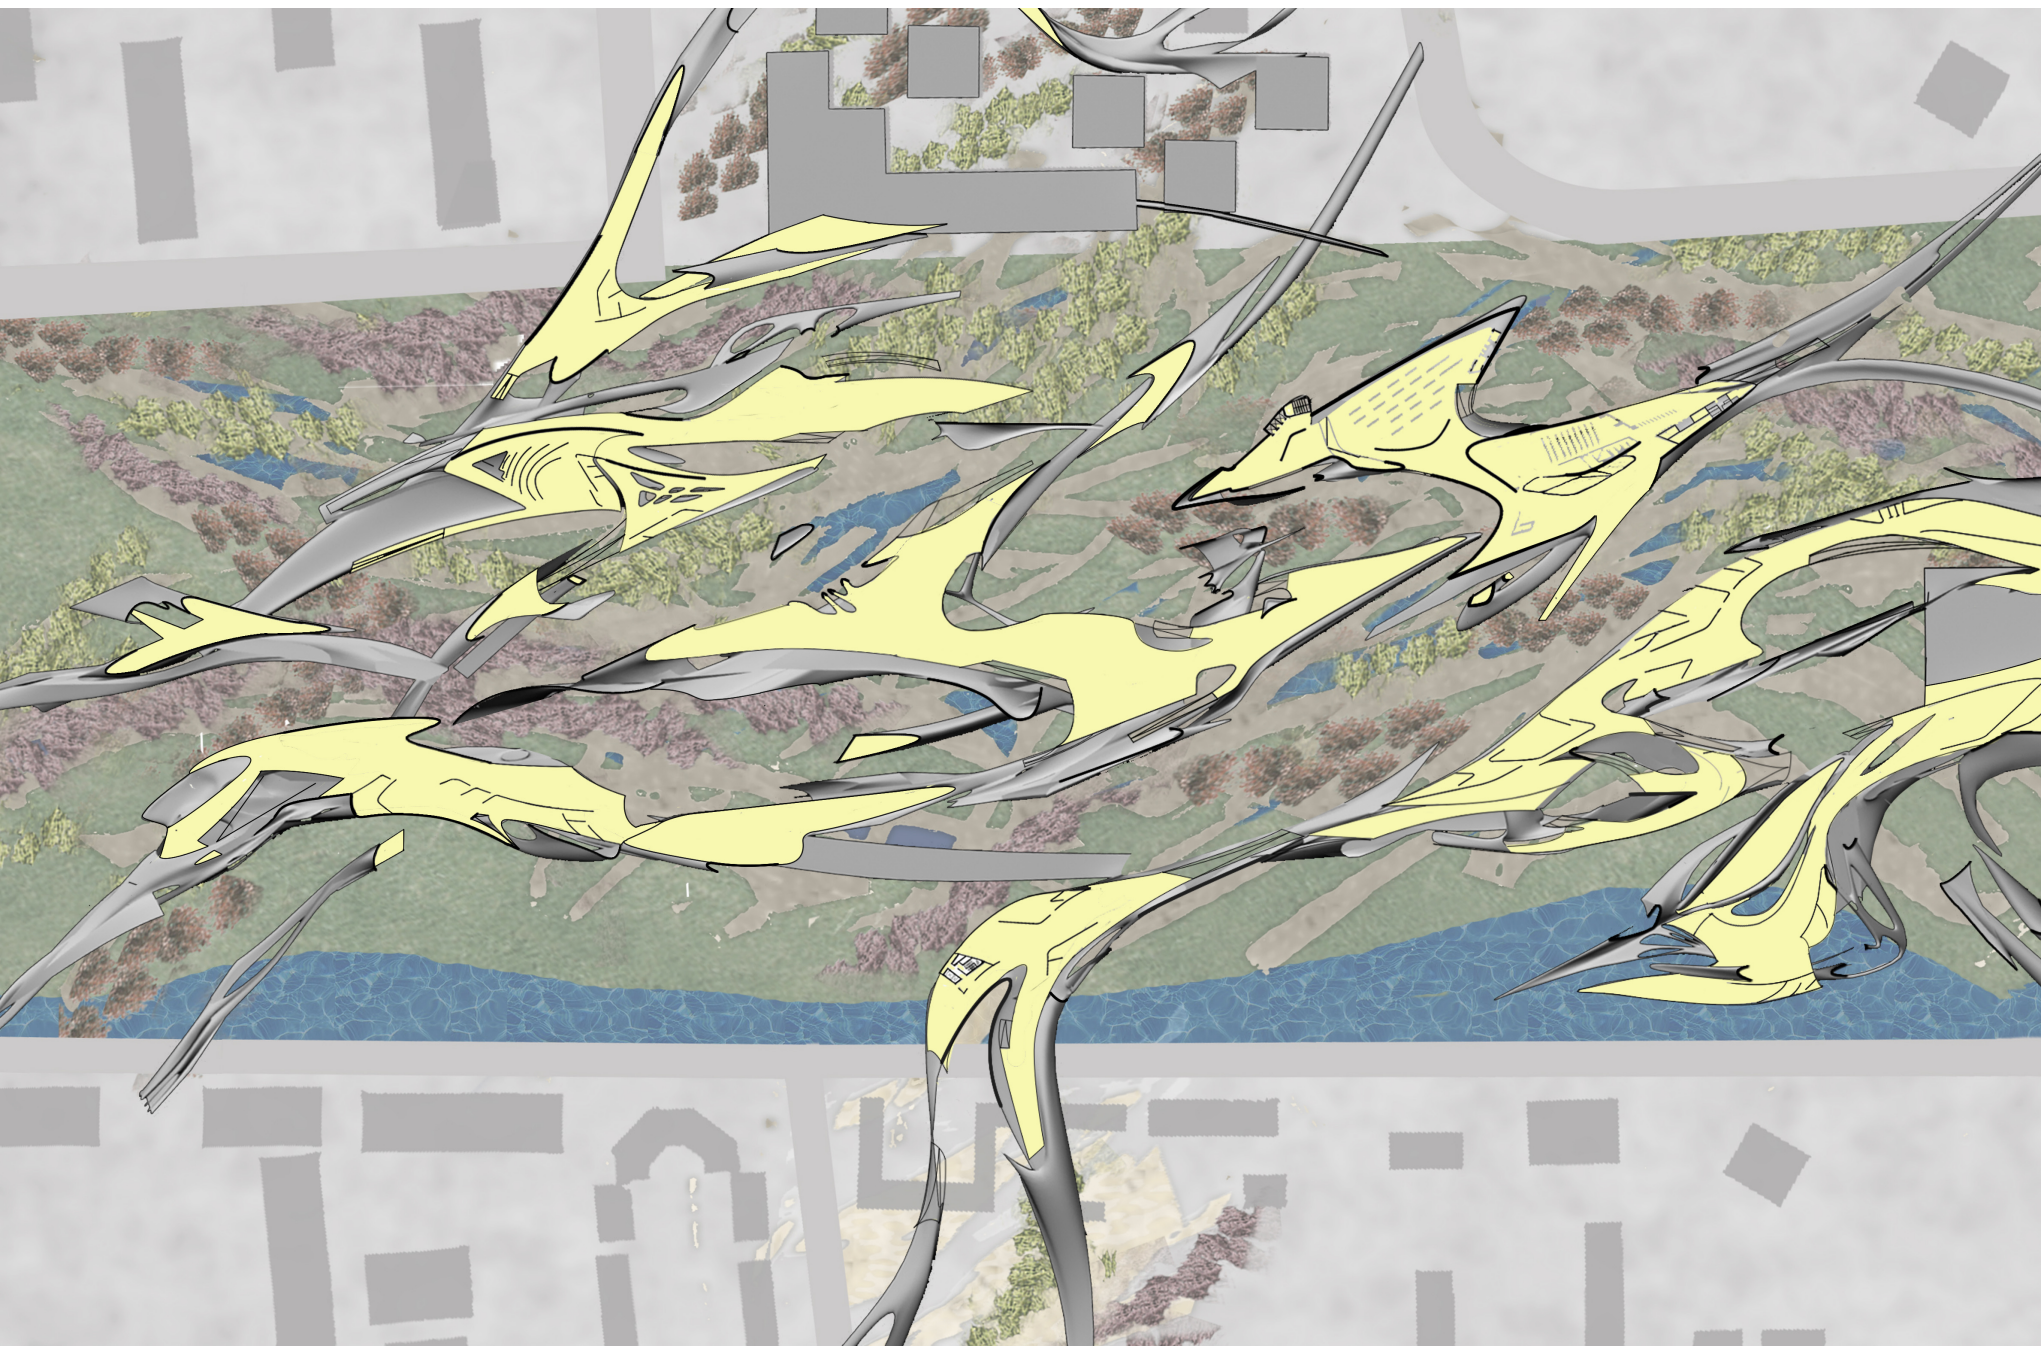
Sviluppo planimetrico della componente attività/attività-attività/spazio- - Pianta del piano primo in scala 1:500
